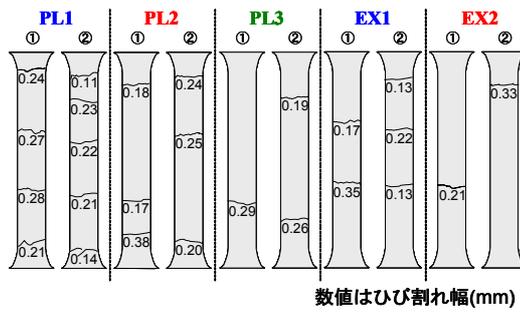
ひび割れ状況(乾燥材齢182日)
